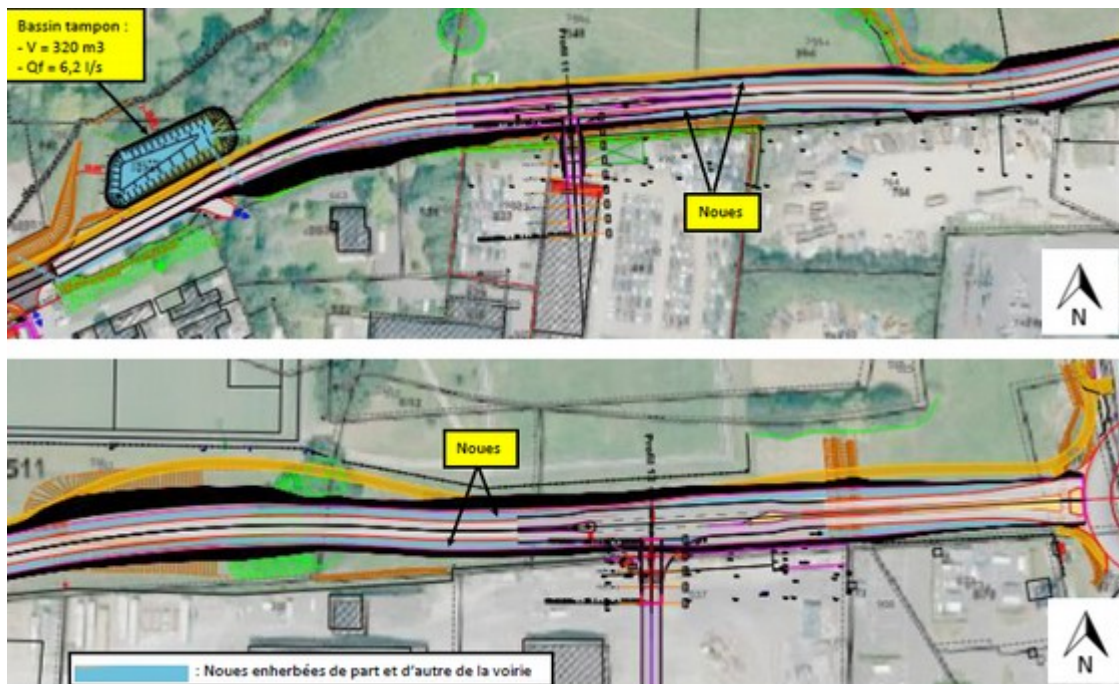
Plan d'assainissement des eaux pluviales (source dossier loi sur l'eau)
